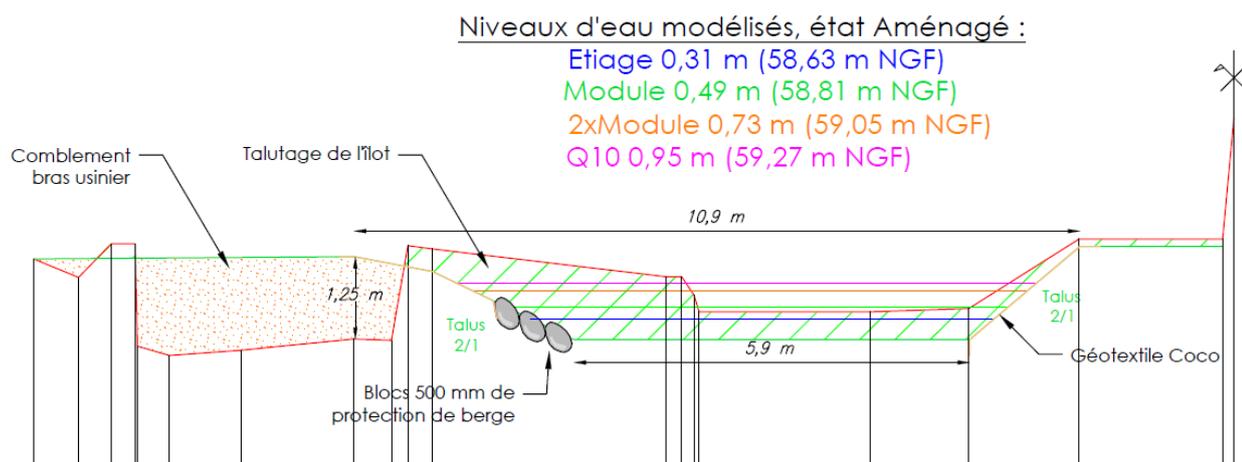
Profil en travers au droit de la mouille aval (PT9,5)
